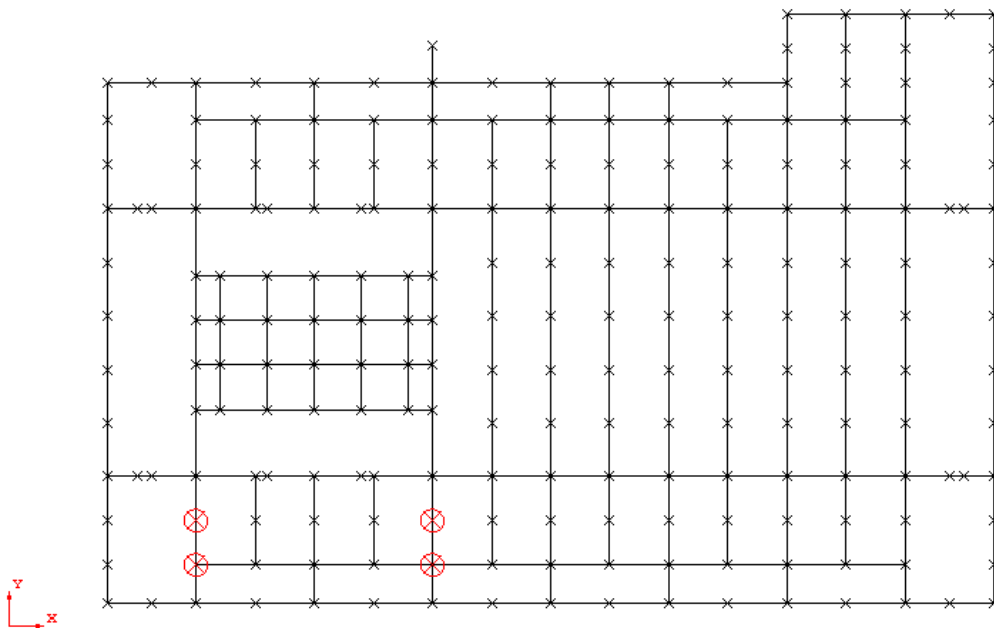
TANQUES DE AGUA – APLICACIÓN DE CARGAS CUBIERTA SUPERIOR
